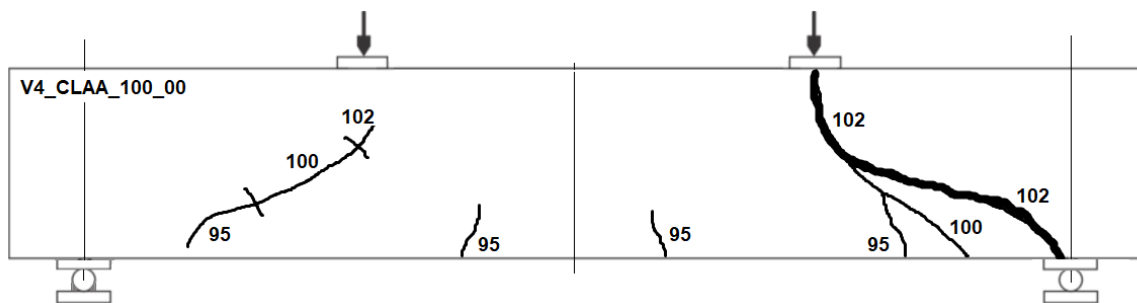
Esquema de fissuração da Viga 4_CLAA_100_00.
